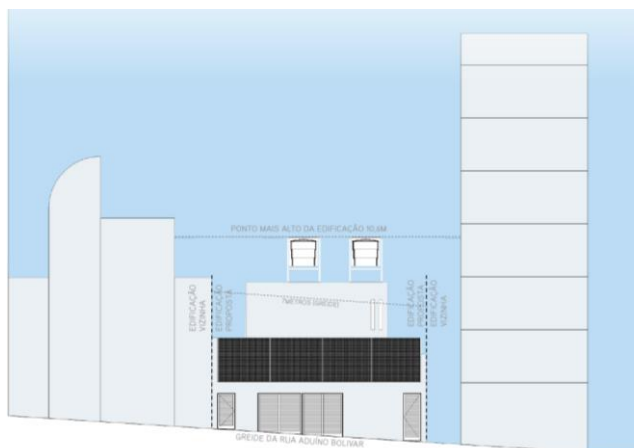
Imagem esquemática que demonstra a edificação proposta em relação às existentes nos lotes lindeiros.
